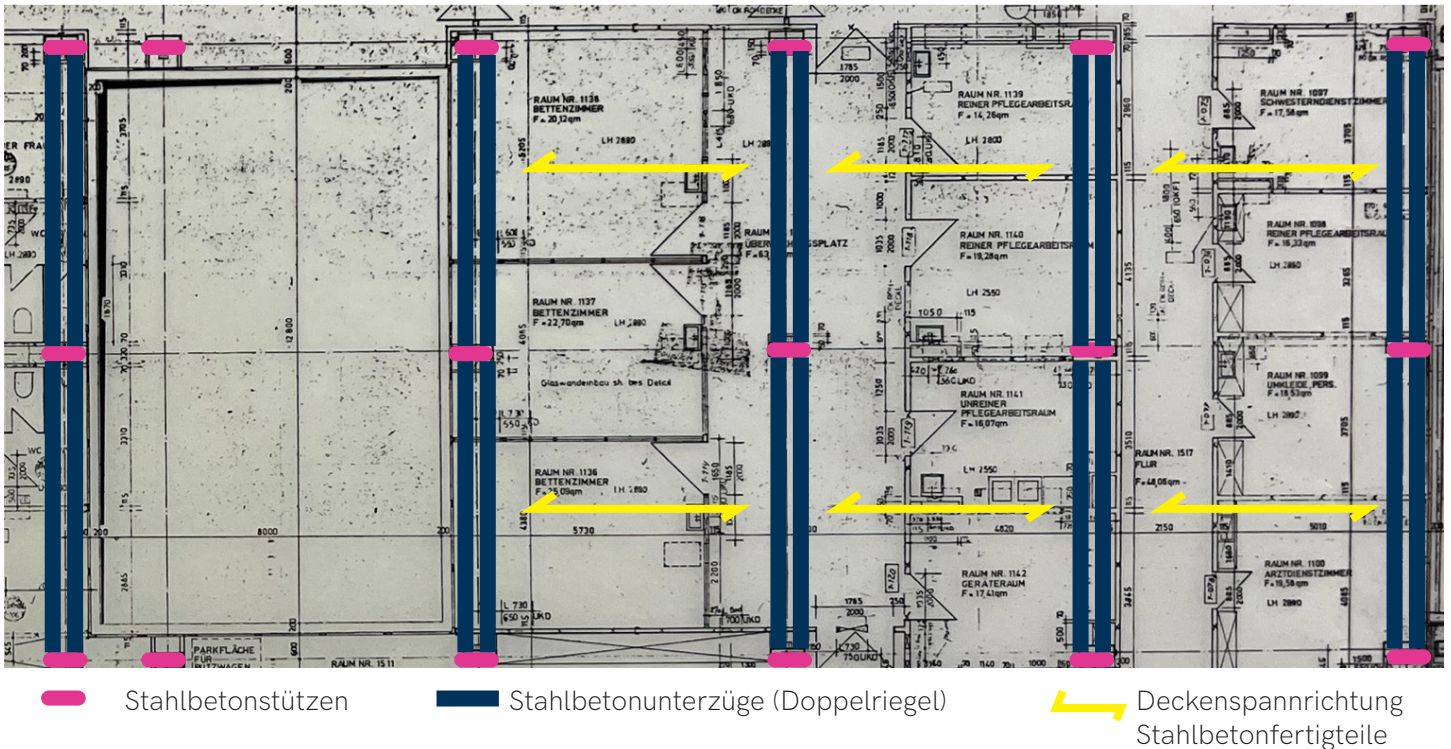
Grundriss- und Treppenhauskasten
